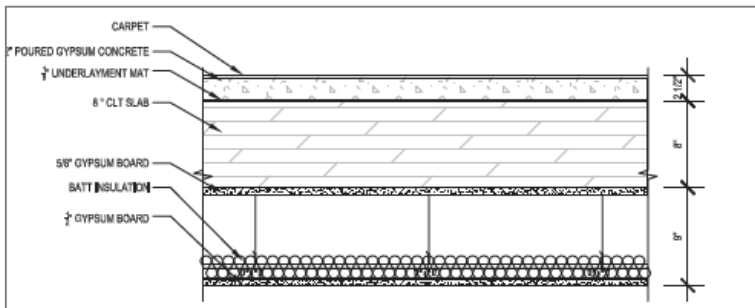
Laje dos apartamentos para venda do Timber Tower Research Project
